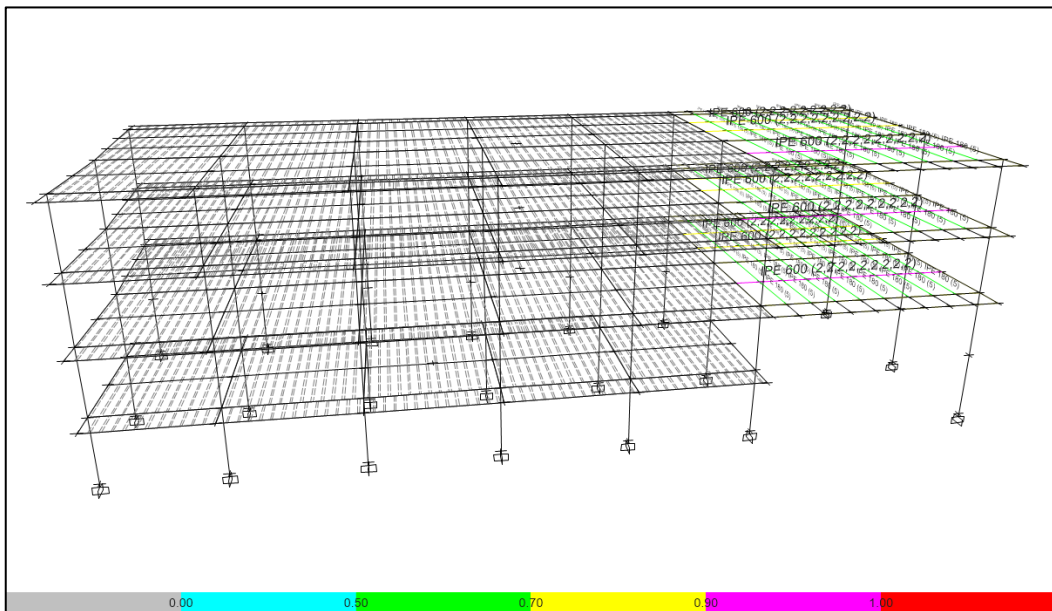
Revisión de criterios en nervios y vigas secundarias de sección metálica
